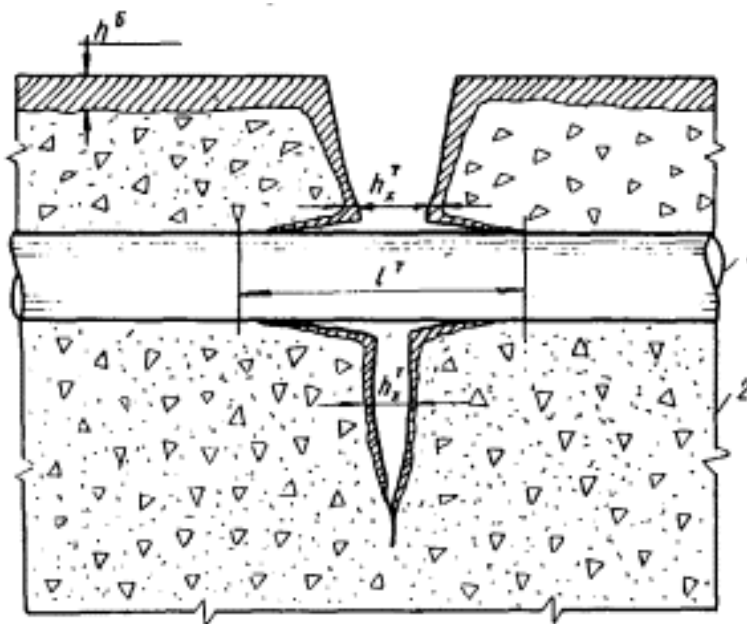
Схема розкриття тріщини в залізобетонному елементі та нейтралізації в бетоні, де: 1-арматура; 2-бетон;
